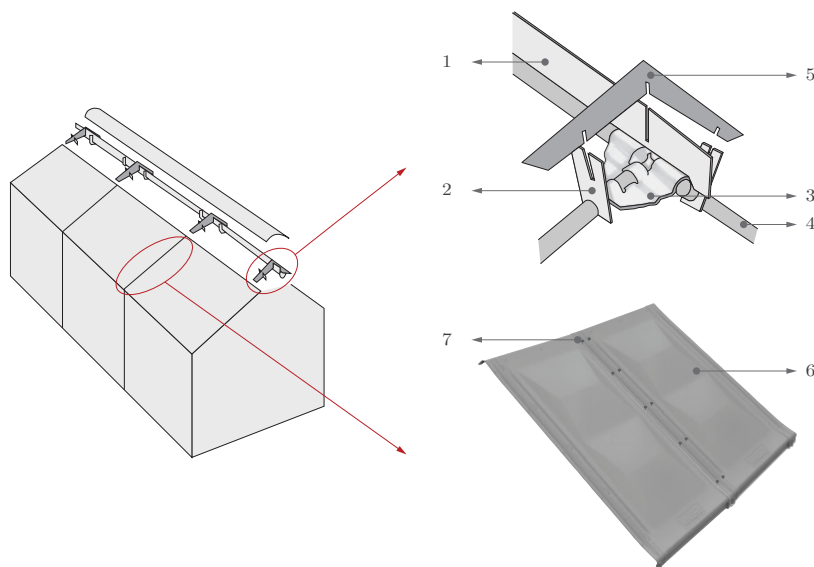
Detalle del ensamblaje simple de la estructura de RHU. Fuente: Vargas (2011).
